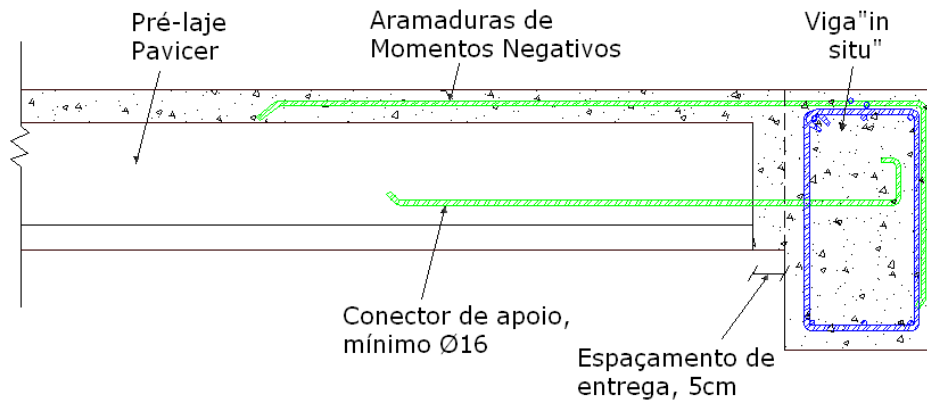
Pormenor tipo de apoio em viga alta de extremidade.
